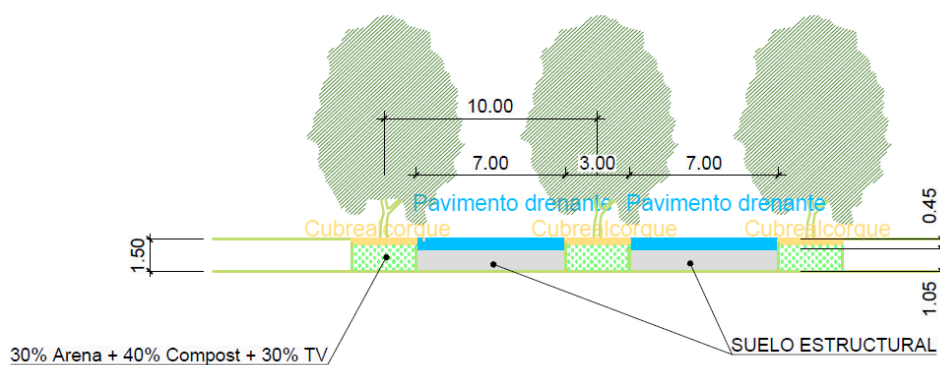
Detalle revegetación. Suelo bajo pavimento.
